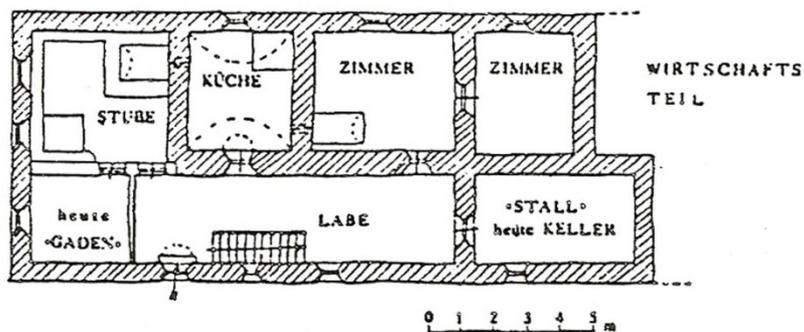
Seitenflurgrundriss, 14.-15. Jahrhundert
